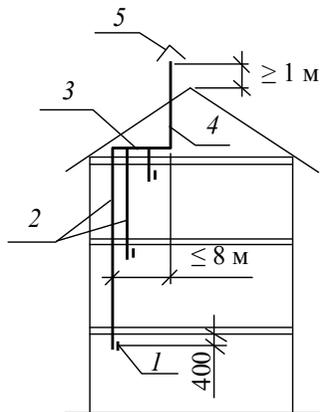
Система вытяжной естественной канальной вентиляции малоэтажного здания
